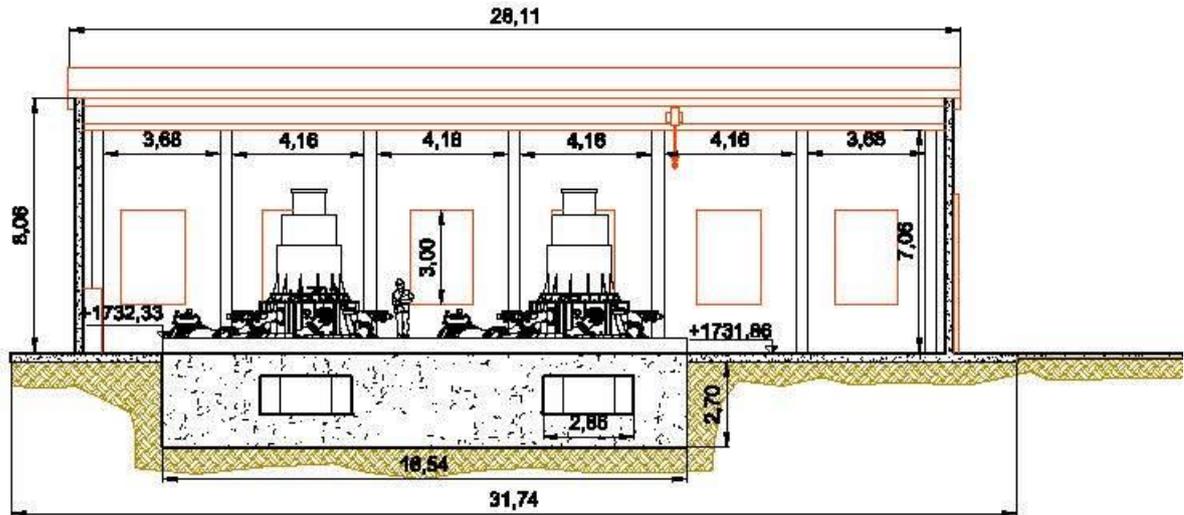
Corte transversal sobre el eje de la casa de máquinas – Fuente Hydrotec SA
